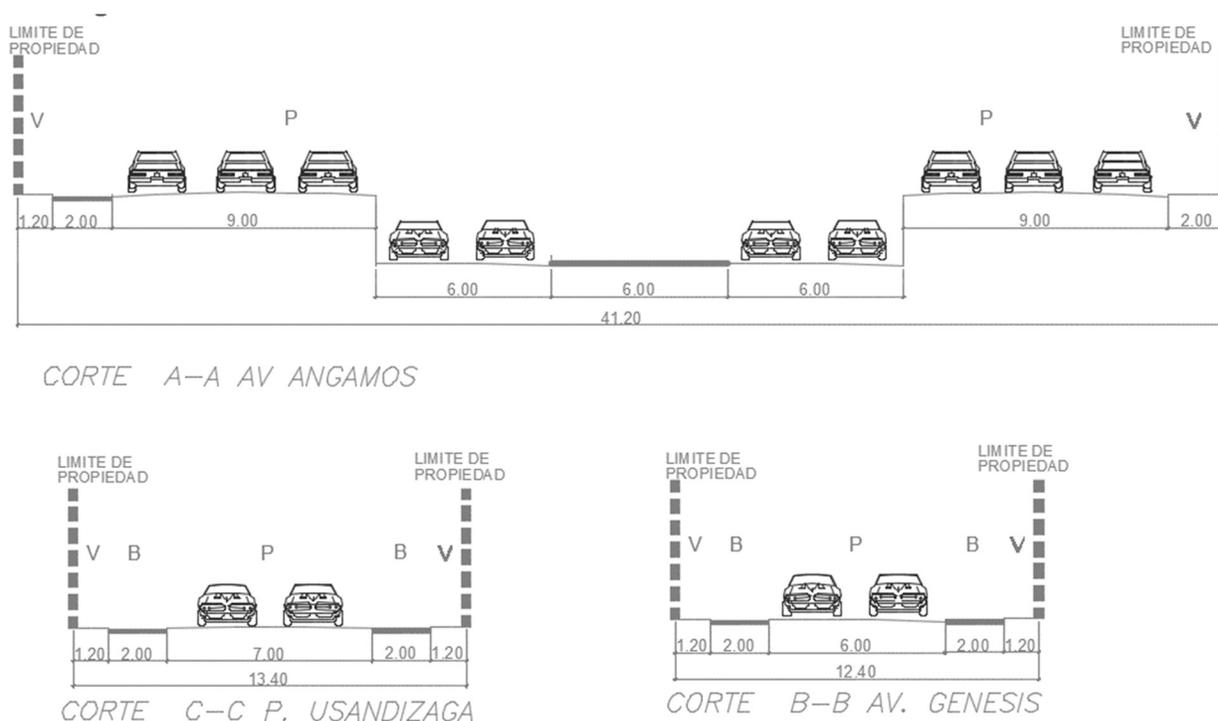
Sección Vial de las Avenidas y Calles del terreno
